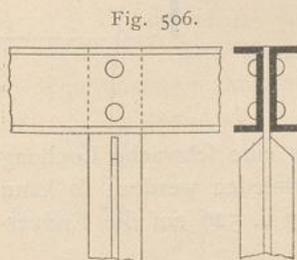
zeigt den unmittelbaren Anschluß einer solchen +-Steife an die aus zwei E-Eisen mit Schlitz gebildete Gurtung eines Trägers.
